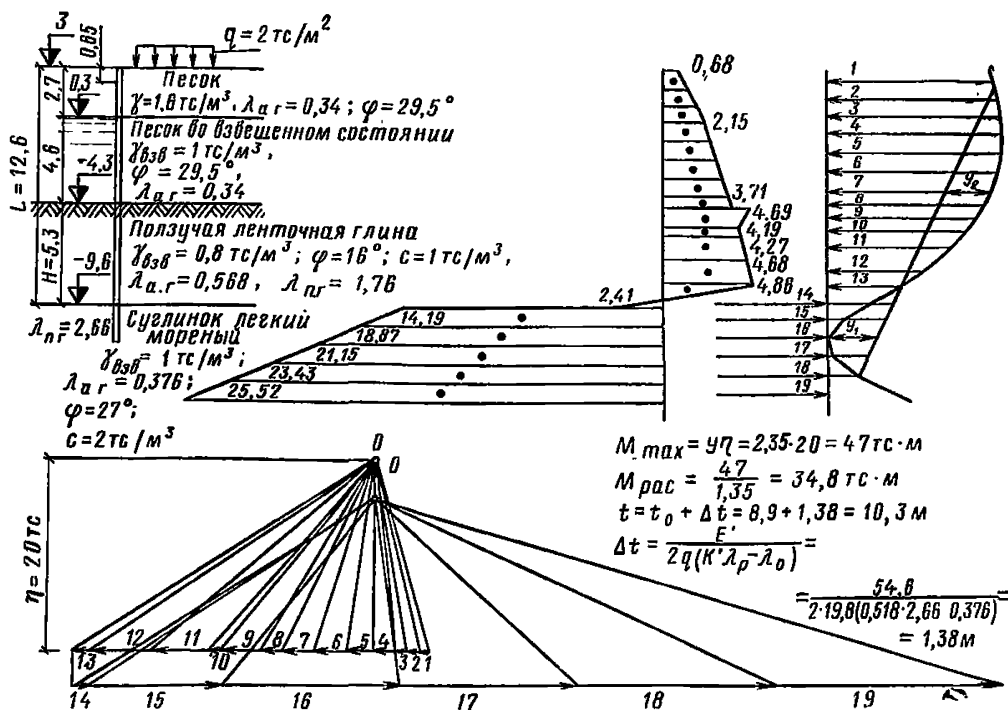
Расчетная схема одноанкерной шпунтовой стенки
